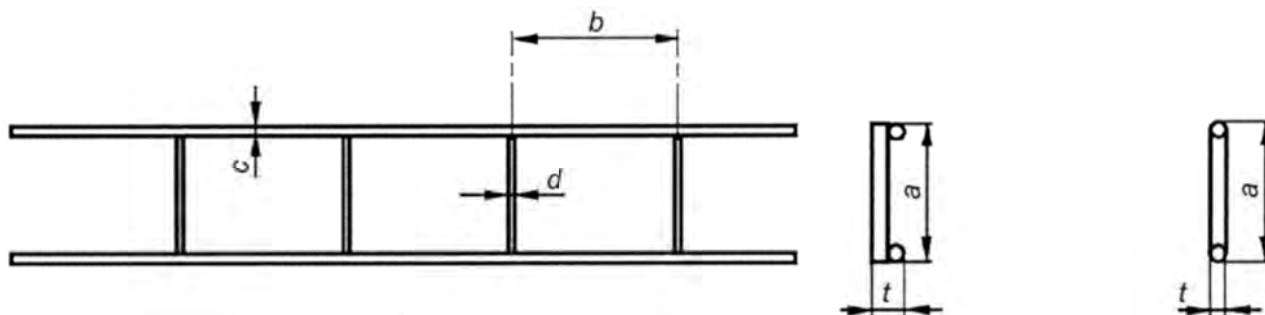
Сетка решетчатого типа: вид сверху и поперечное сечение
